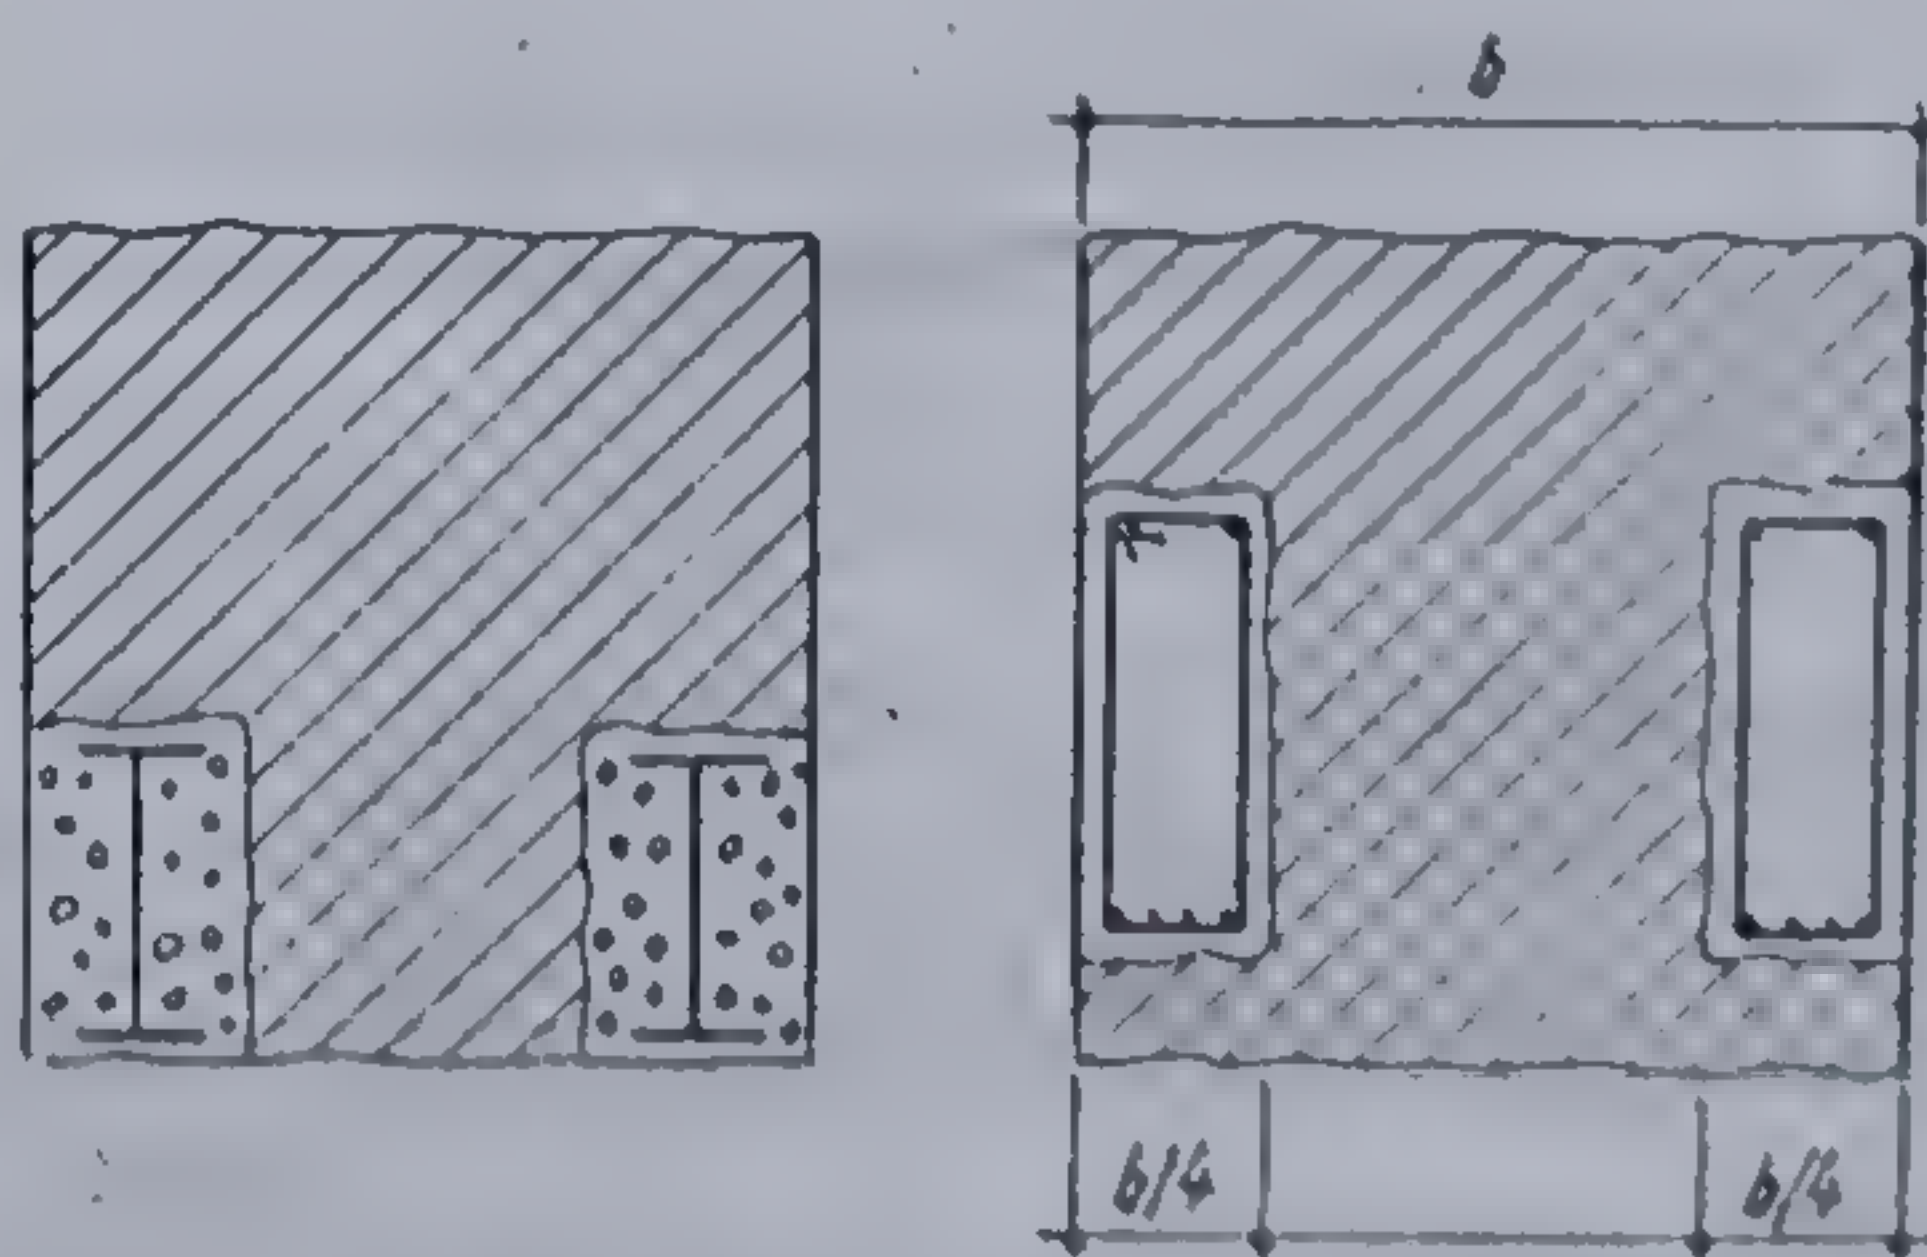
Centuri din beton armat pentru consolidarea fundațiilor de zidărie.
